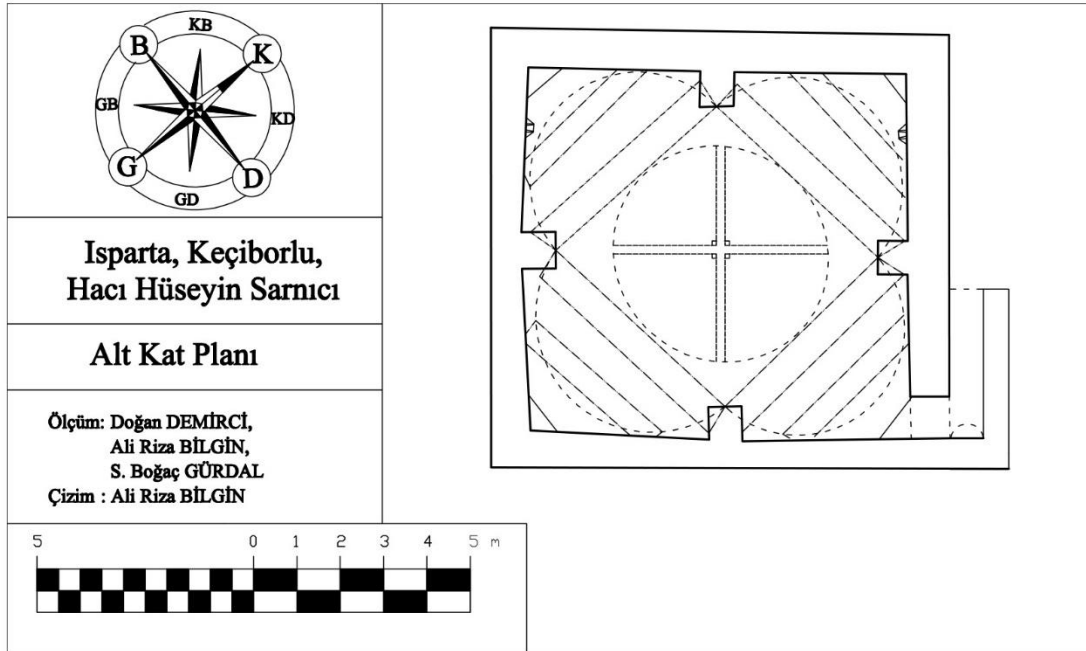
Hacı Hüseyin Sarmıcı, Alt Kat Plan.
